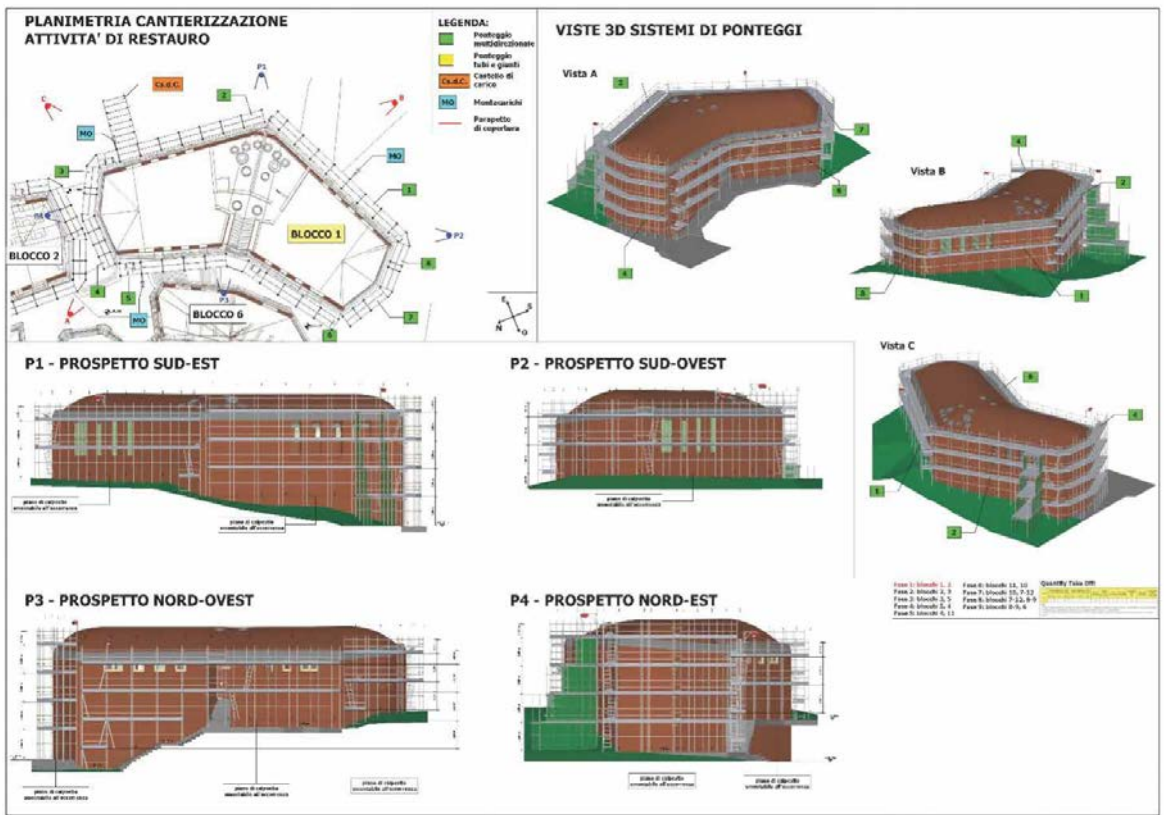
| Diseño del sistema de andamiaje, lámina TIPO A (ejemplo Fase 1 – Bloque 1). | Progetto del sistema di ponteggi, elaborato TIPO A (esempio Fase 1 – Blocco 1).
